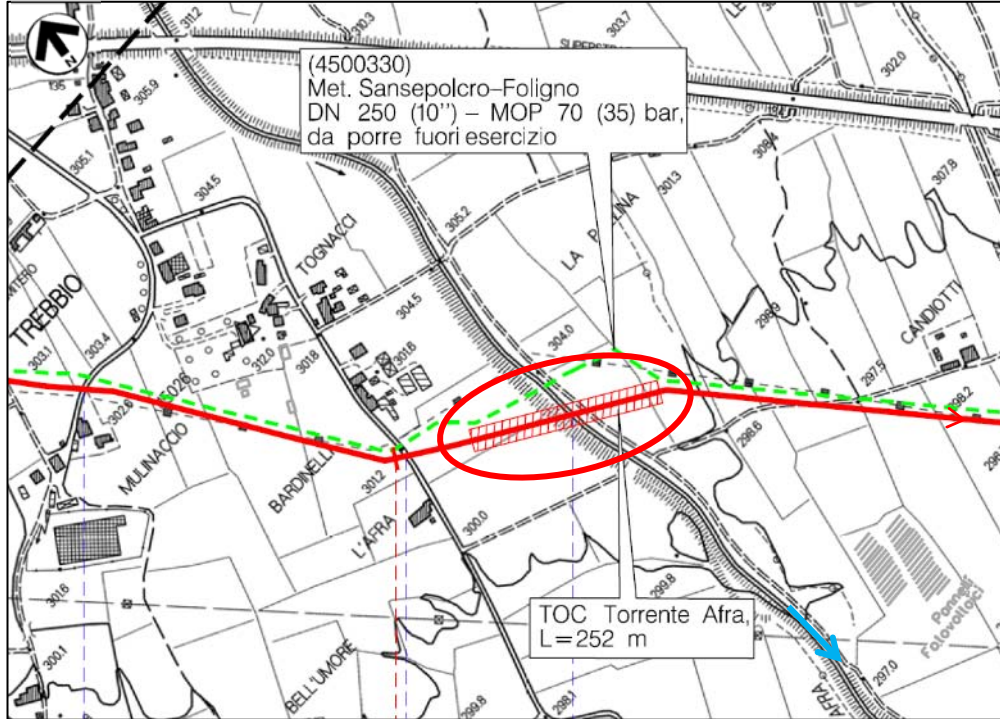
/B – Stralcio CTR con localizzazione dell’attraversamento
